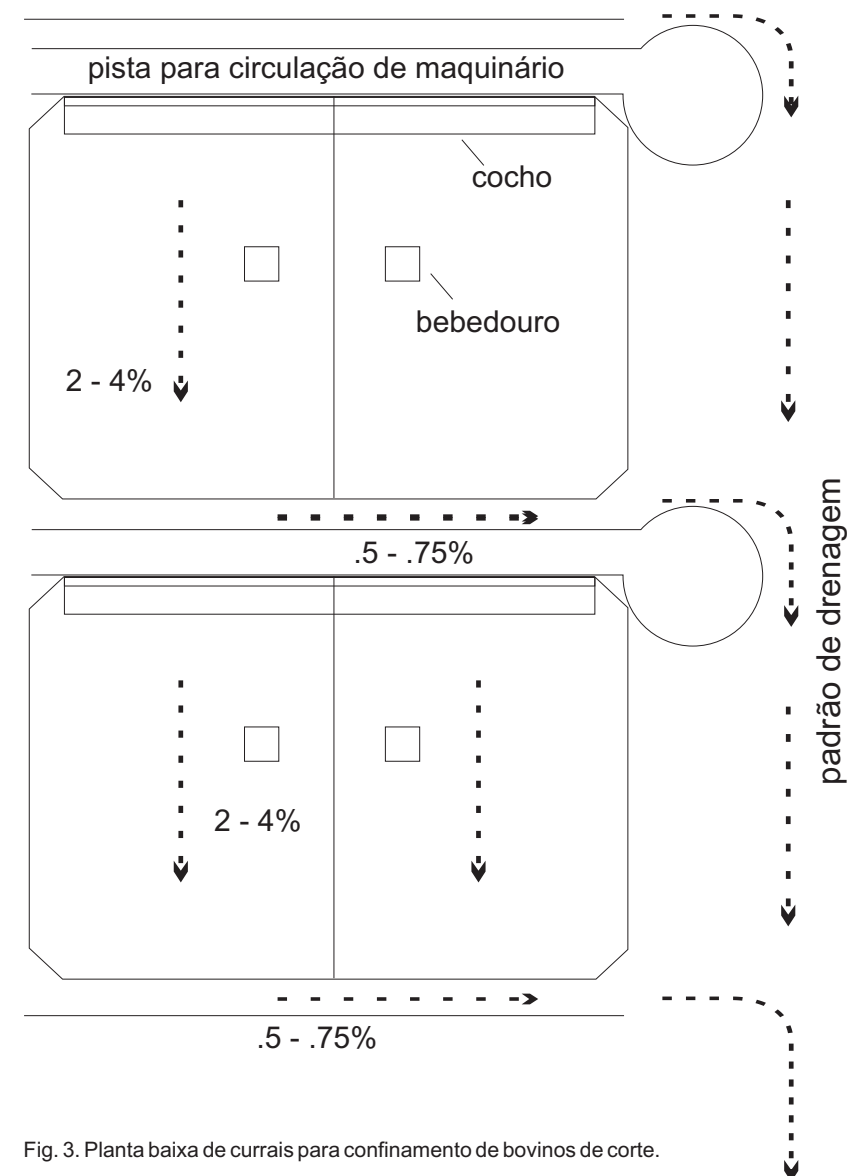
Planta baixa de currais para confinamento de bovinos de corte.
